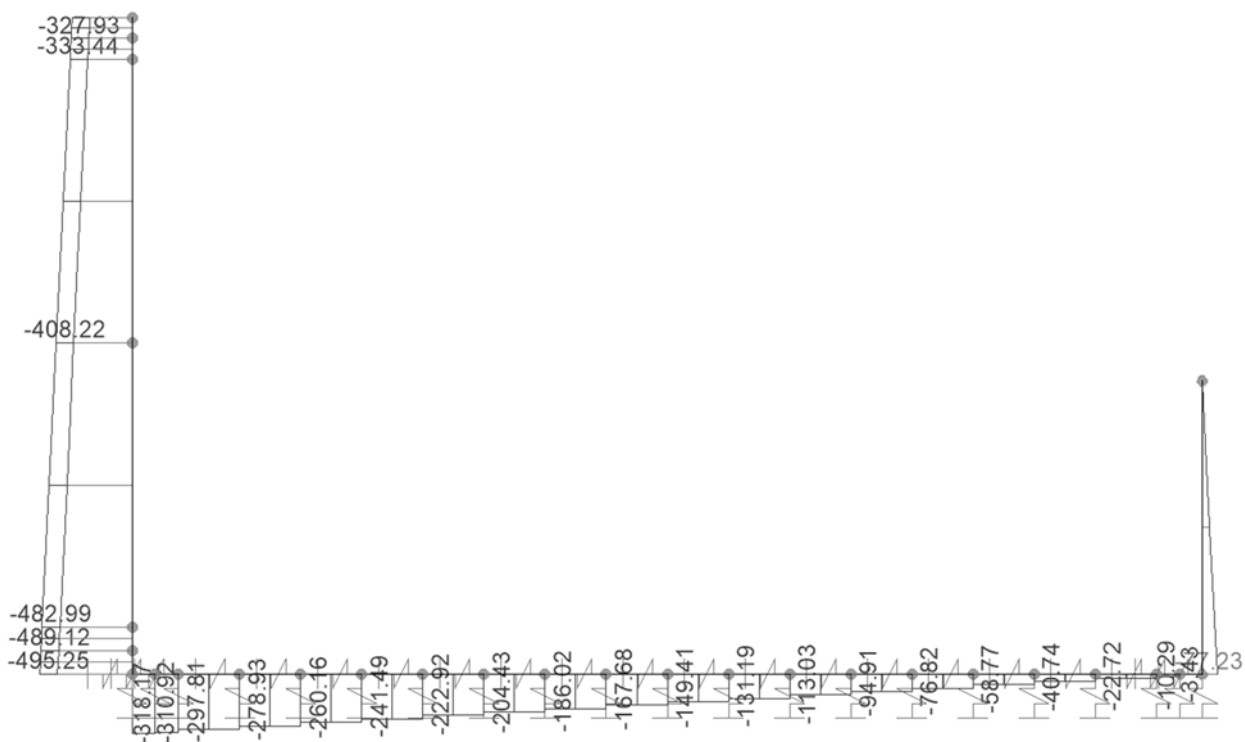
SLE.rara – Piedritto e platea di fondazione – Sforzi assiali Ned
